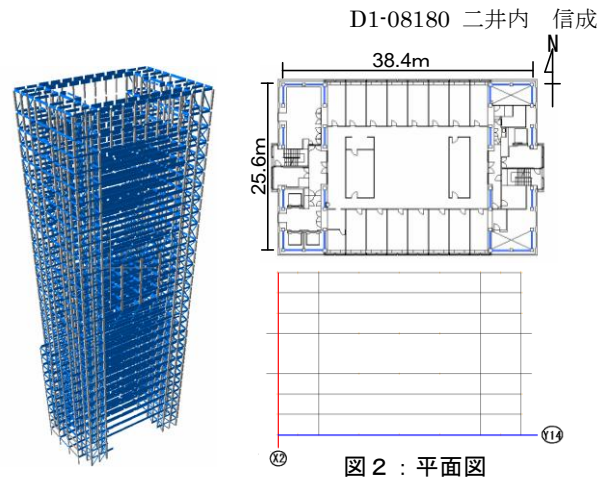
：アクソメ図 上：基準階平面図 下：基準階伏図
